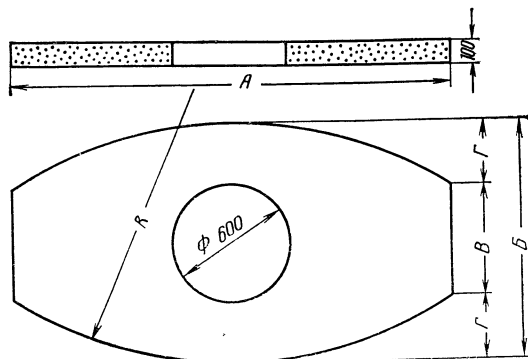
Железобетонные перекрытия для проходных кирпичных колодцев типов ККС-3, ККС-4, ККС-5
